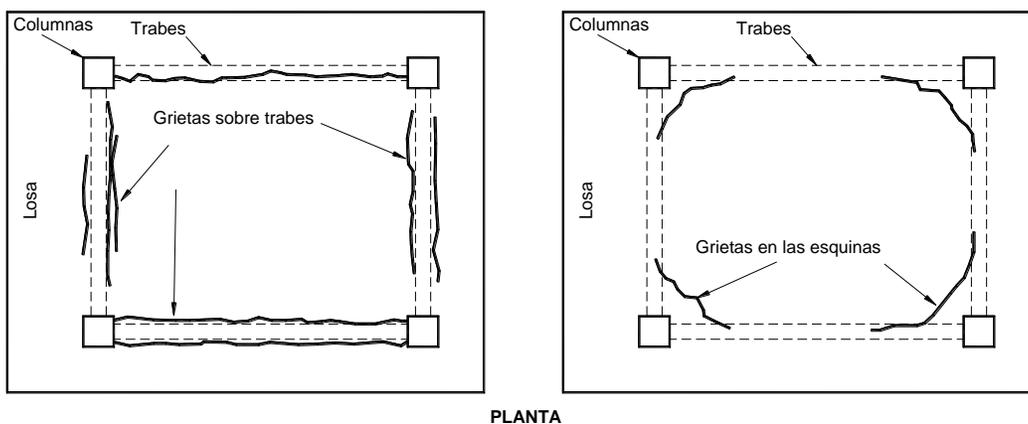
Grietas en losas sobre trabes perimetrales y en esquinas
